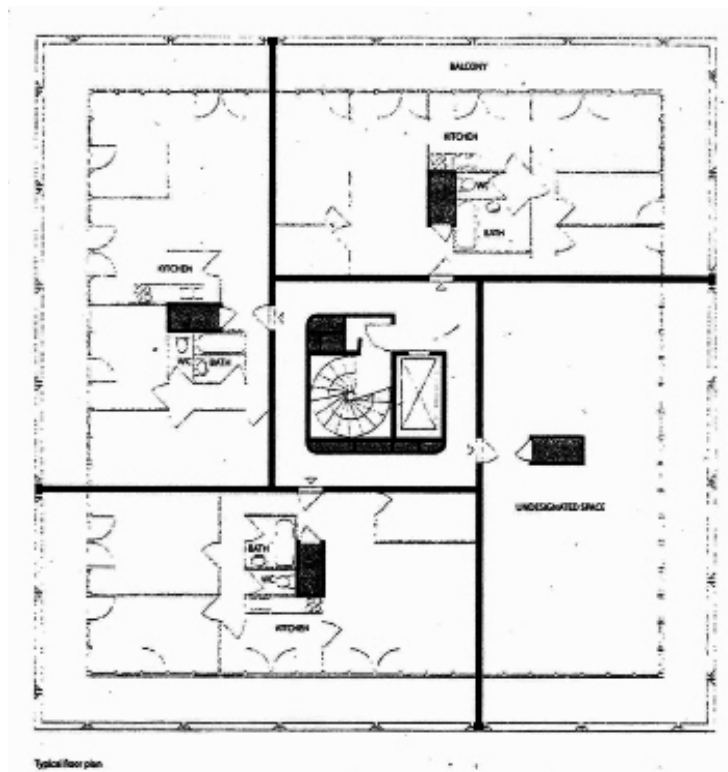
Projeto de Luc e Xavier Arsène-Henry (1971) - Planta de frações
